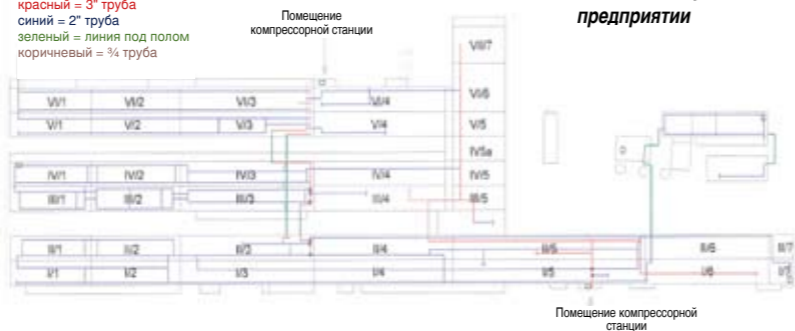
Общий план основного трубопровода сжатого воздуха на предприятии
